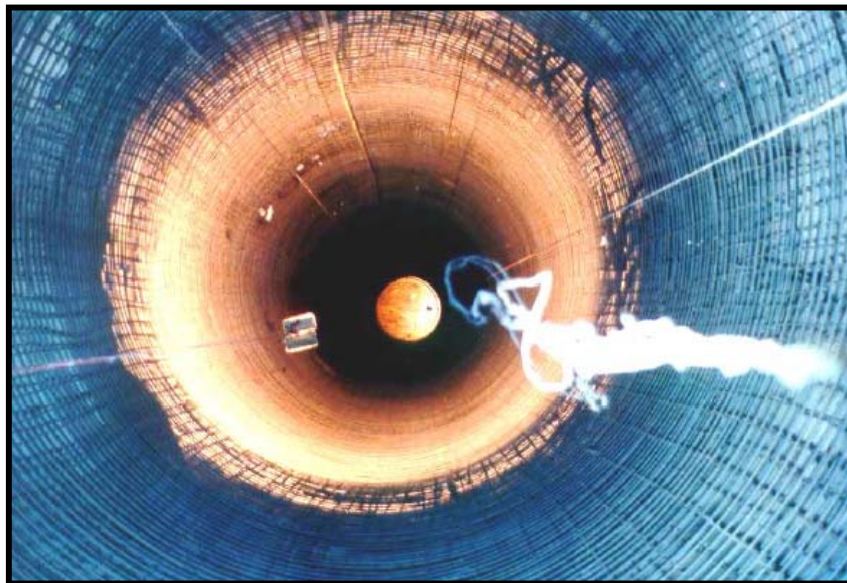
Colocación de acero de refuerzo para el revestimiento con concreto en lumbreras
